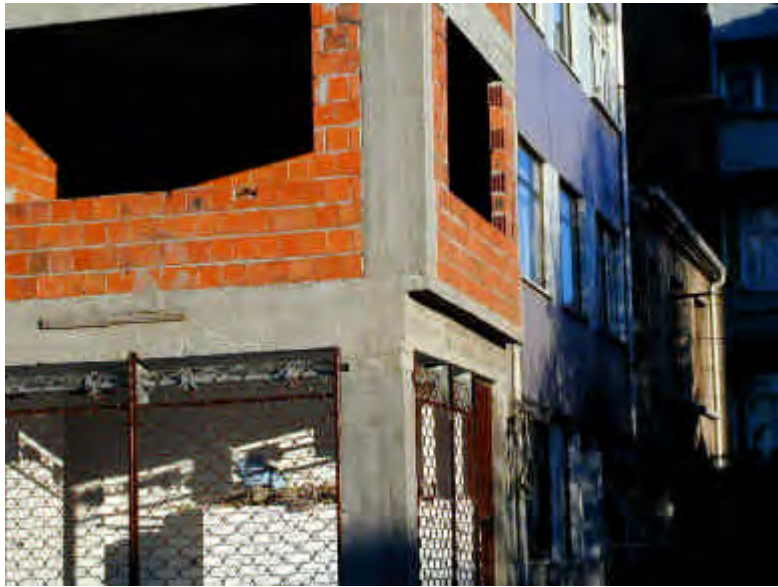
La ausencia de control facilita que se cometan errores en la construcción.
